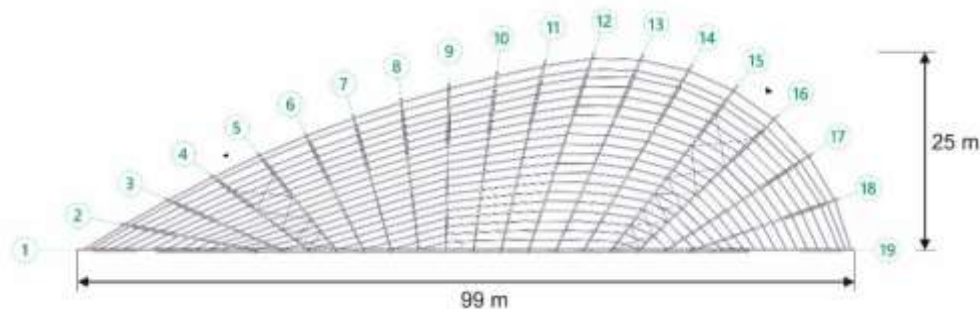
Planta de la estructura de cubierta (Oak Ingeniería)
